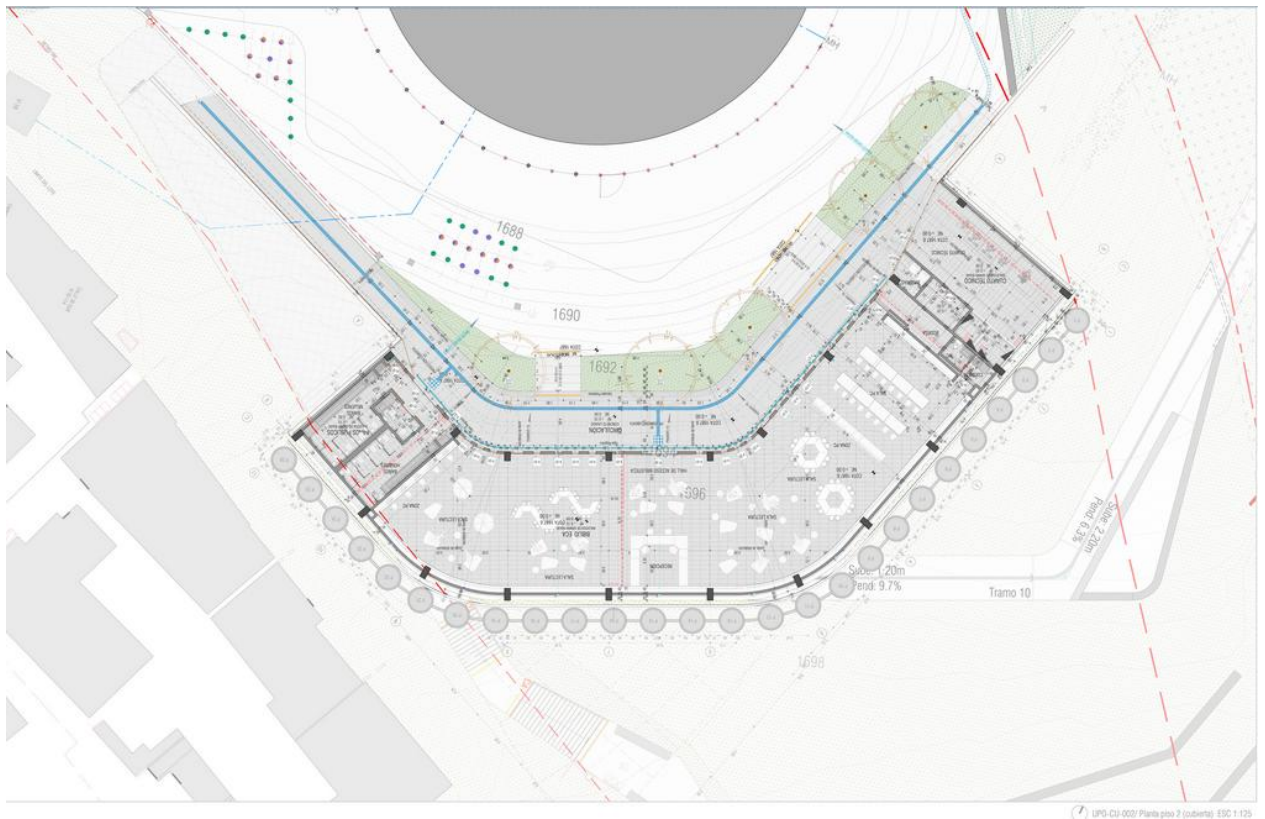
Planta baixa Biblioteca. Fonte: site EPM.
